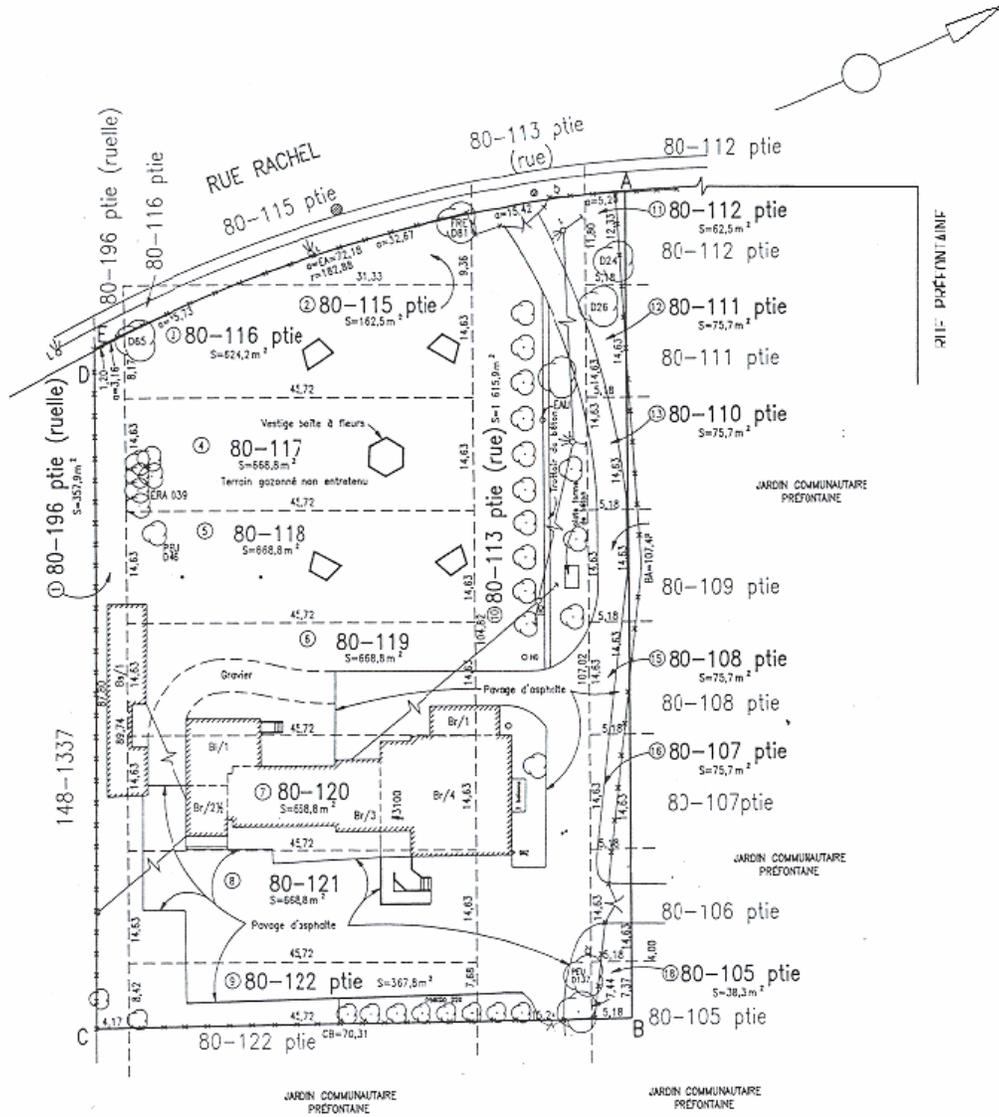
Plan de cadastre du site (Ville de Montréal).
